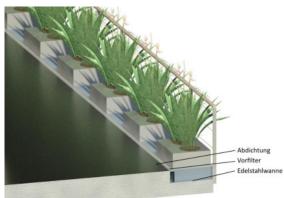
Balkonbrüstung Neubau Installation des Wasserbeckens
